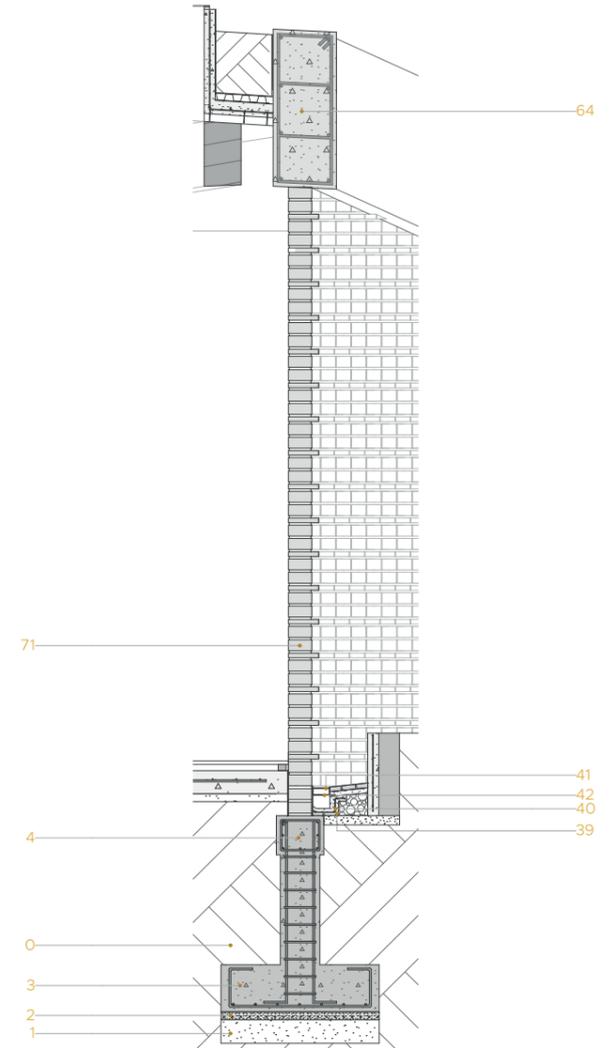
\_C4: detalle constructivo\_03, viga prefabricada
